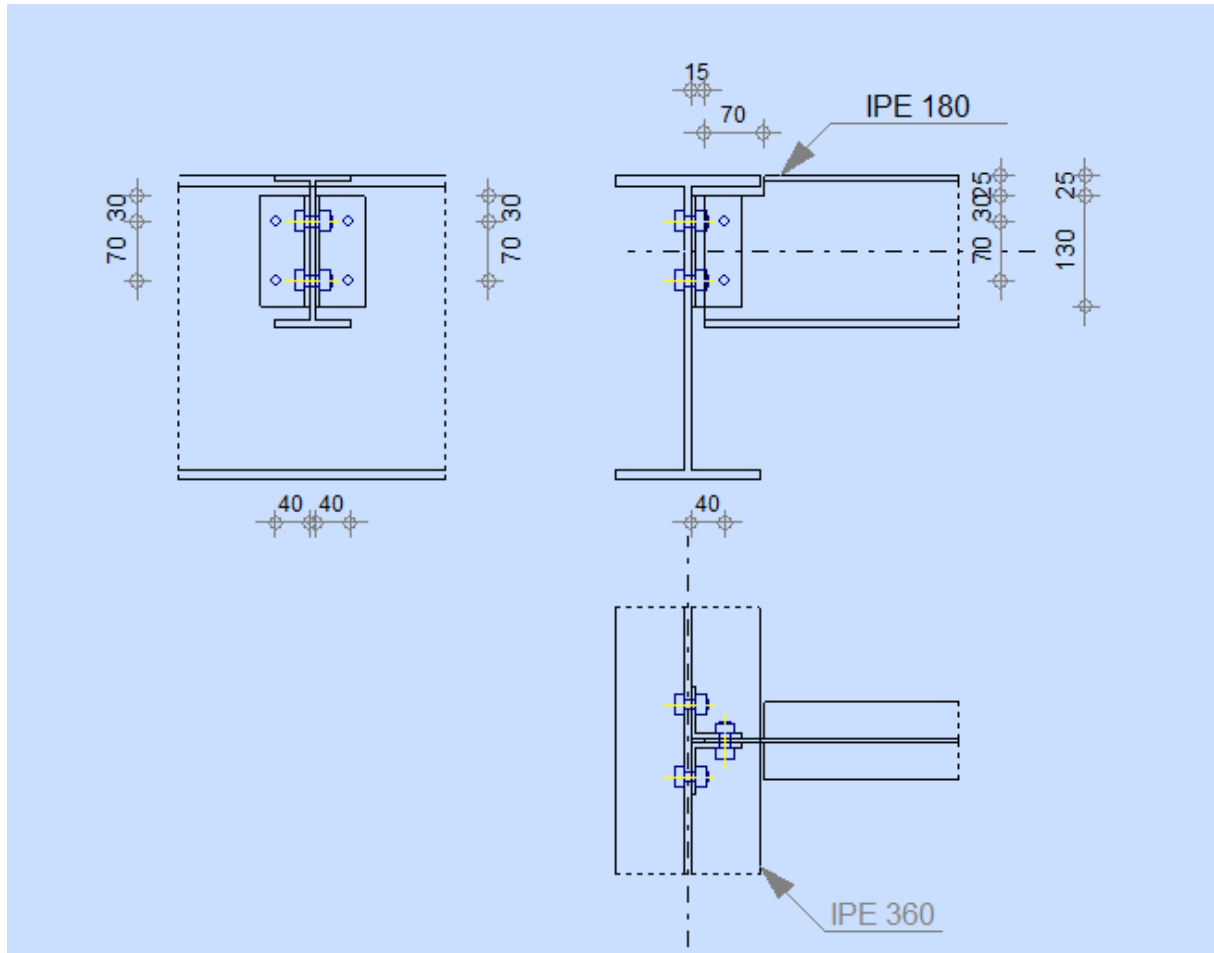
Représentation de l'assemblage poutre maitresse - solive.
